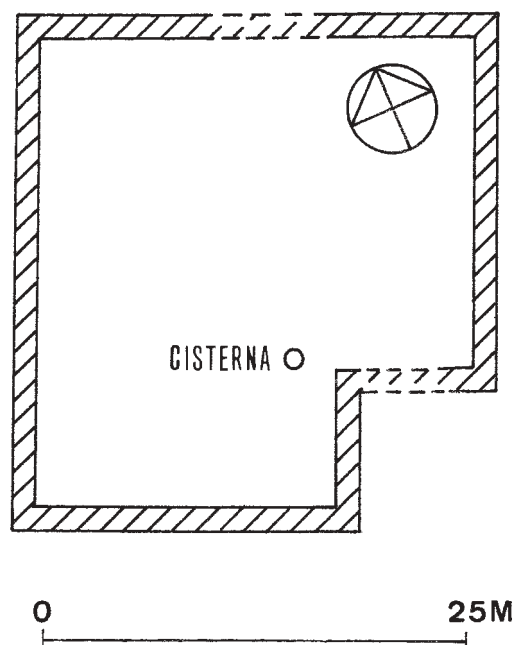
Planta do Castelo Belinho (Portimão) (seg. J. Palhinha).
